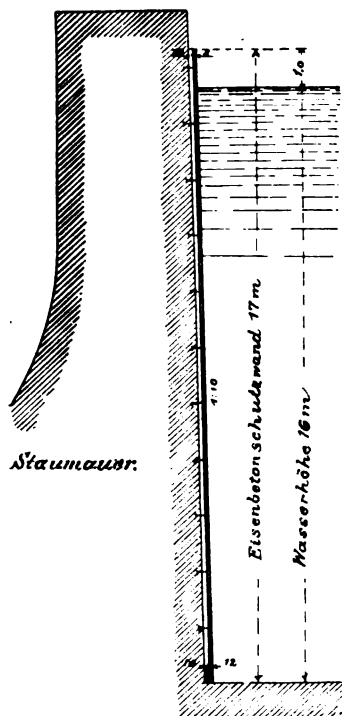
Eisenbetonschutzwand an der Mouche-Talsperre in Saint-Ciergues.
